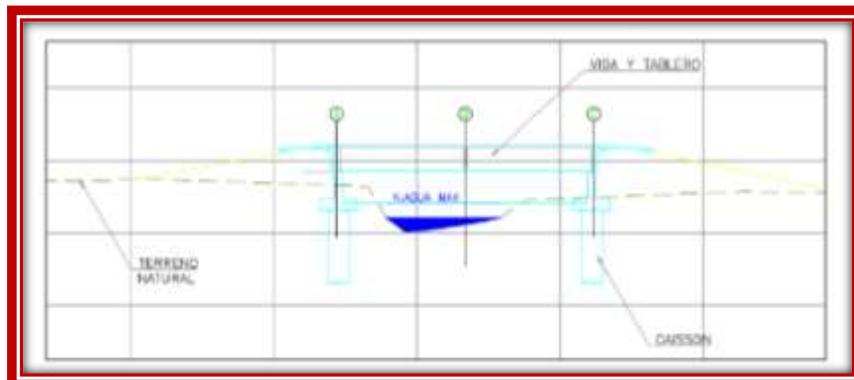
Vista en planta del Puente Proyectado Quebrada Las Marimbas
